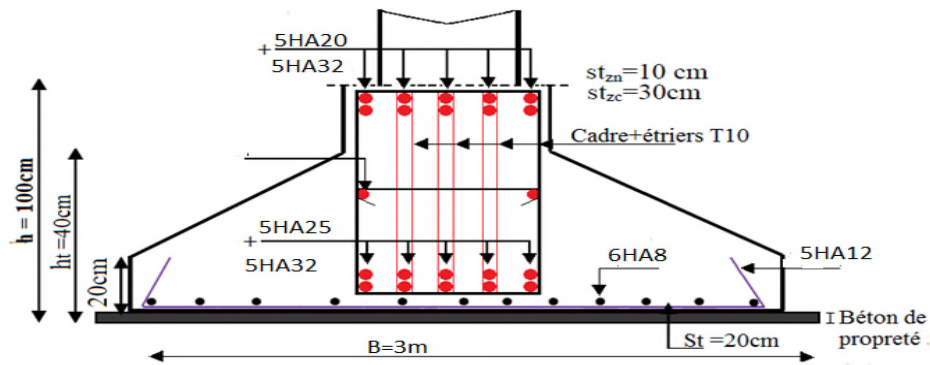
Exemple de schéma de ferrailage de la semelle filante 1
